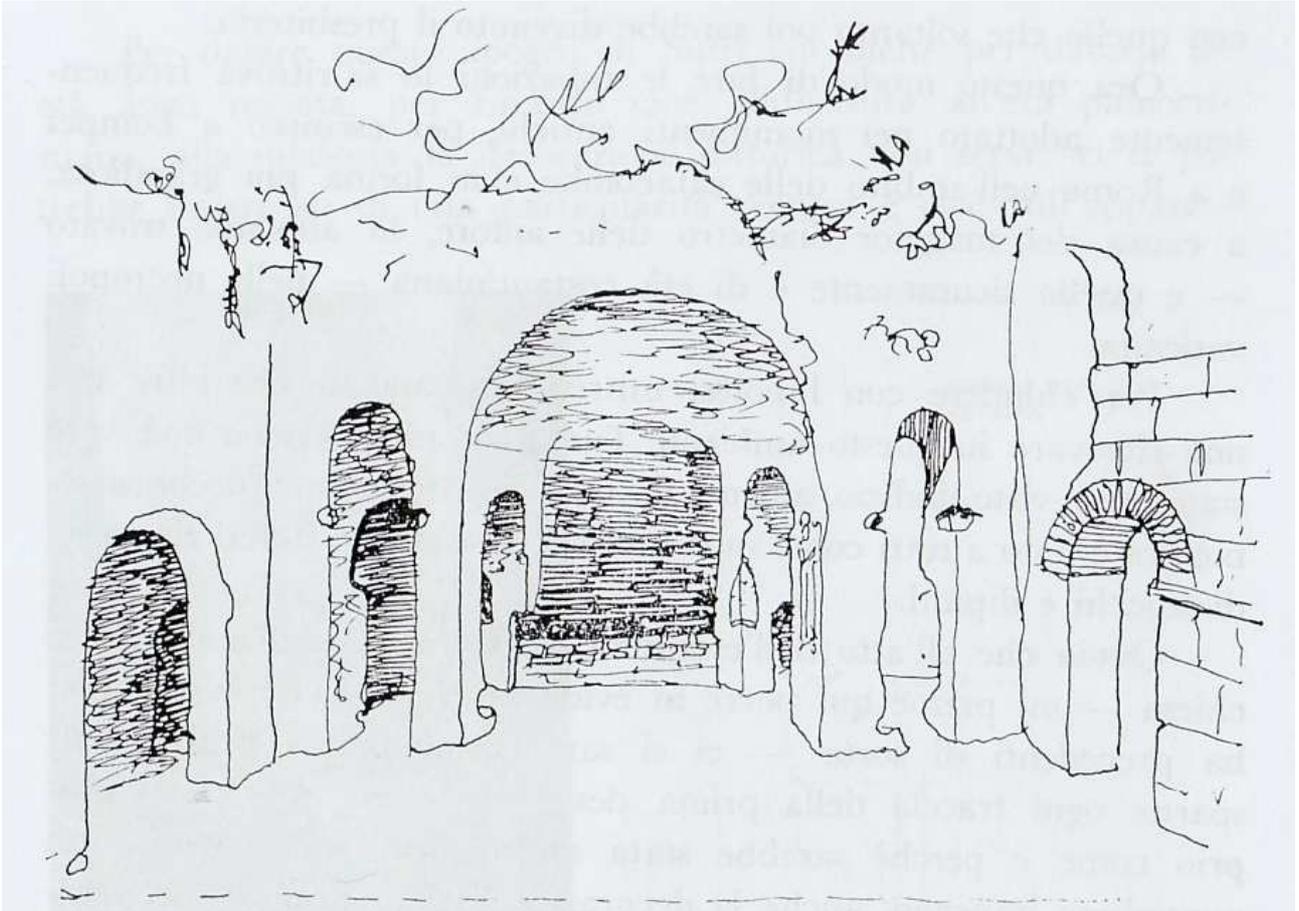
Prospetto schematico dell'assetto dell'area presbiteriale (fonte: Apollonj Ghetti 1986).
